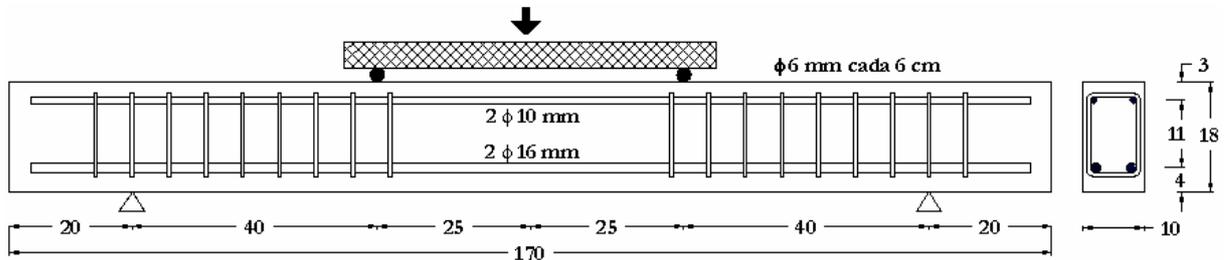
Detalhamento da viga de Lim e Oh (1999) com 75% da área de armadura necessária para o reforço ao corte (vigas S0.75-0 e S0.75-1).
